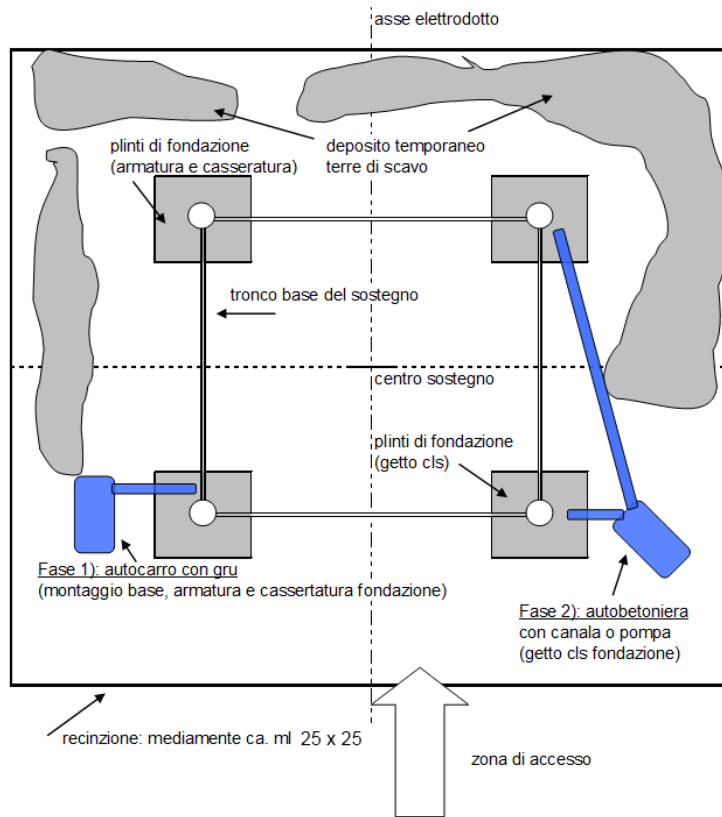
layout tipo dell'area sostegno (getto e montaggio basi)
